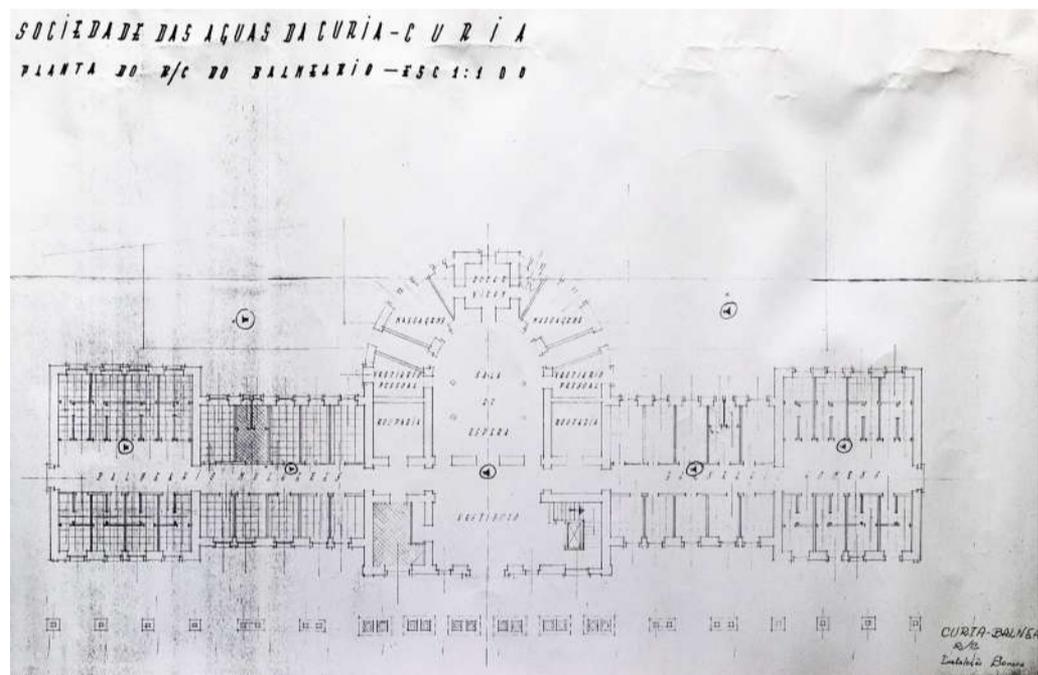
| Planta do 1º andar do antigo balneário (anos 80/90).
